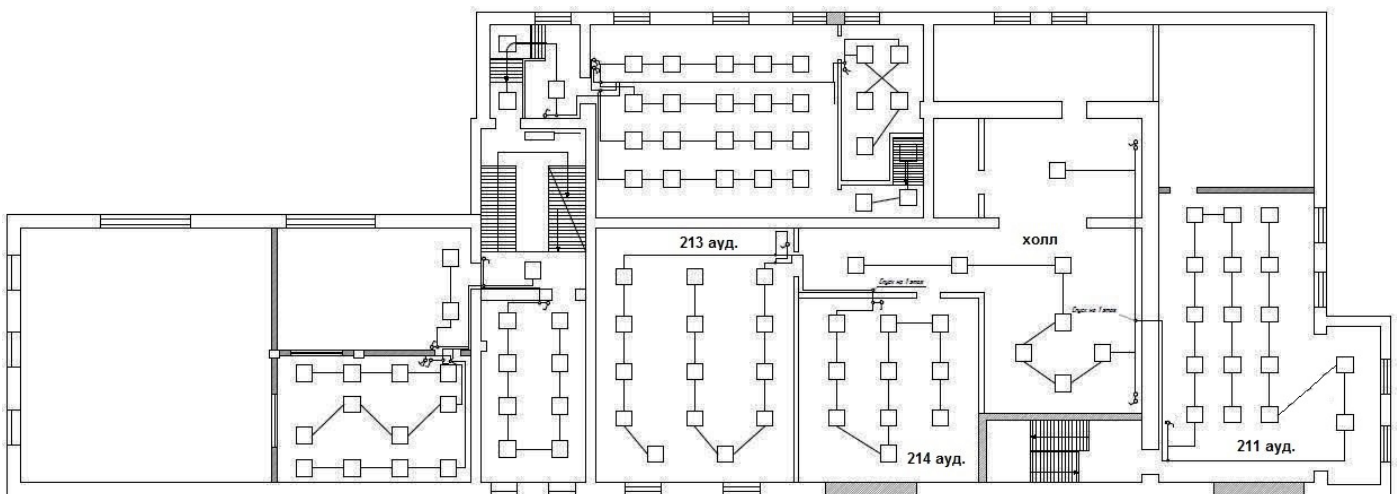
Исполнительный план освещения 2 этажа здания УНЦ ЭИ (после модернизации)
